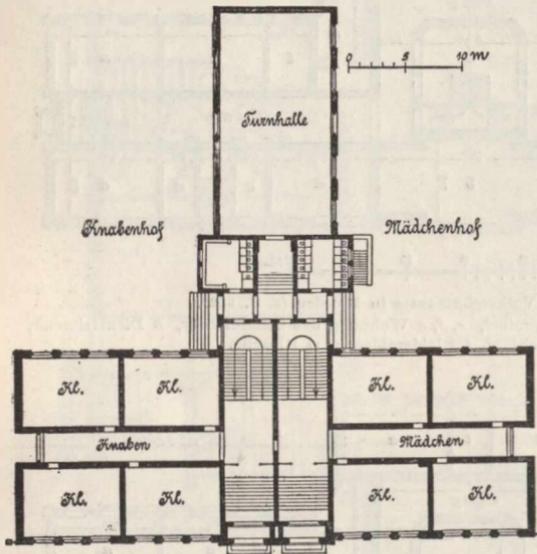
Grundriß vom Erdgeschoß einer Volksschule in Halle a. S. (s. S. 652).
